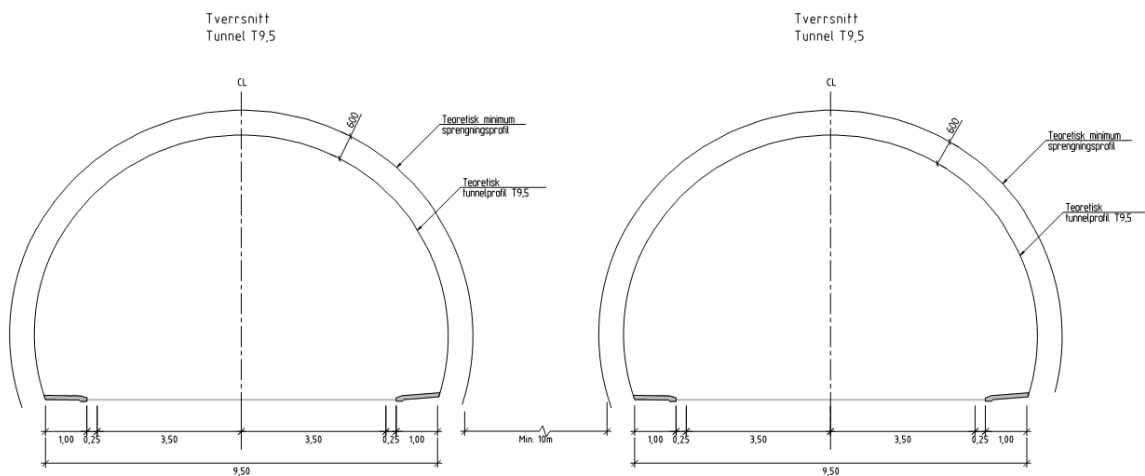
Tunnelprofil 2 x T9,5 for toløps tunnel
